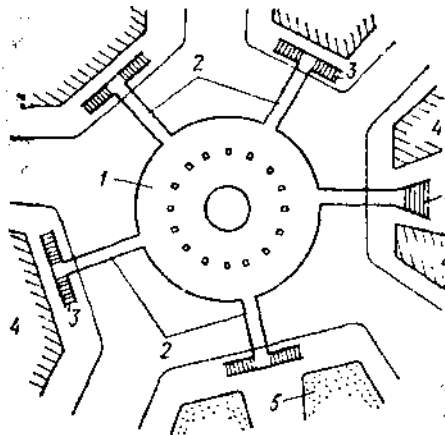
Схематичний план кругової площі з пішохідними тунелями:
